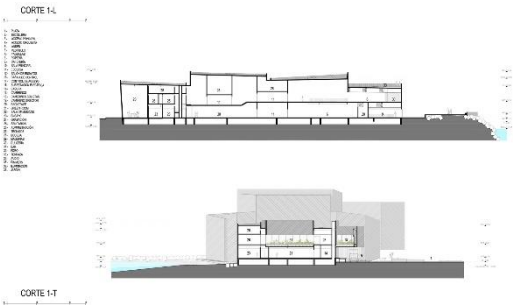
corte longitudinal y transversal, foro boca. Fuente: Archdaily
